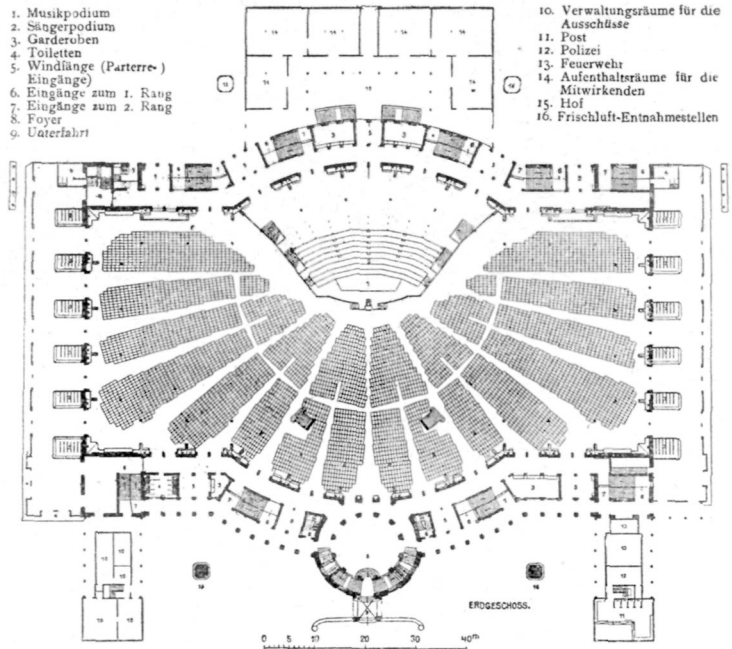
Festhalle zu Frankfurt a. Main. Grundriß
